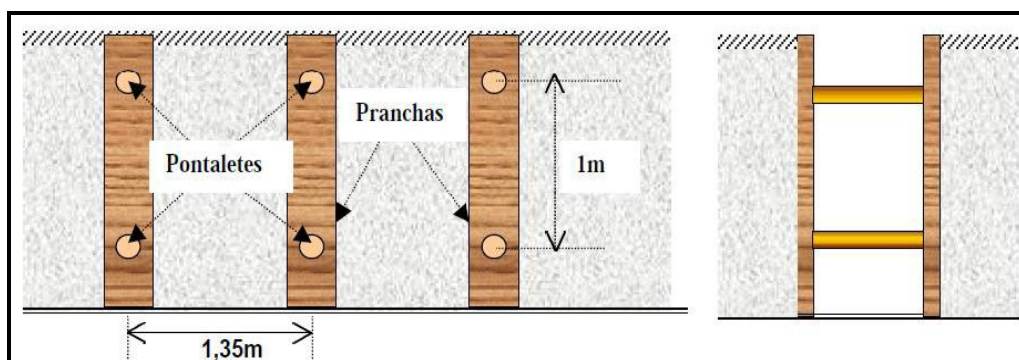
Pontaleteamento (corte longitudinal e transversal)
